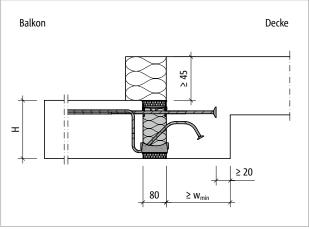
Schöck Isokorb® T Typ KL-U: Balkon mit Höhenversatz nach unten und Außendämmung
